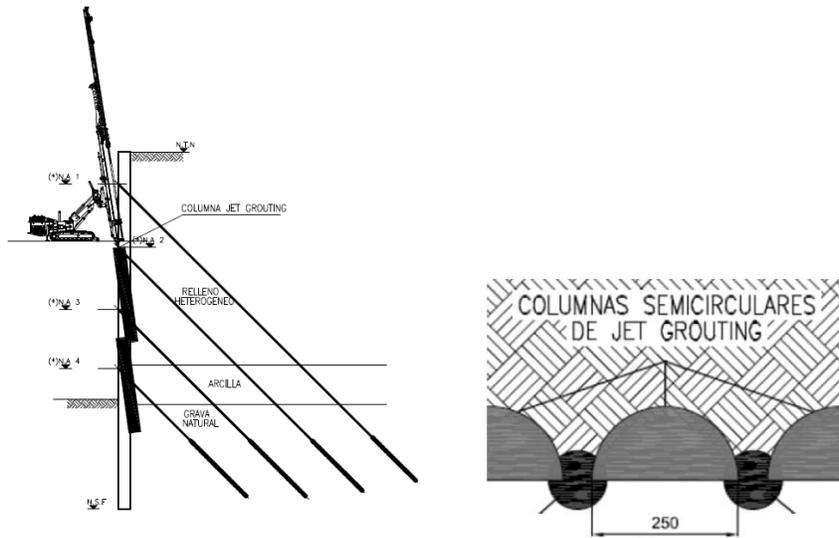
Esquema de ejecución de Jet Grouting (izq.: corte y der.: vista en planta)
